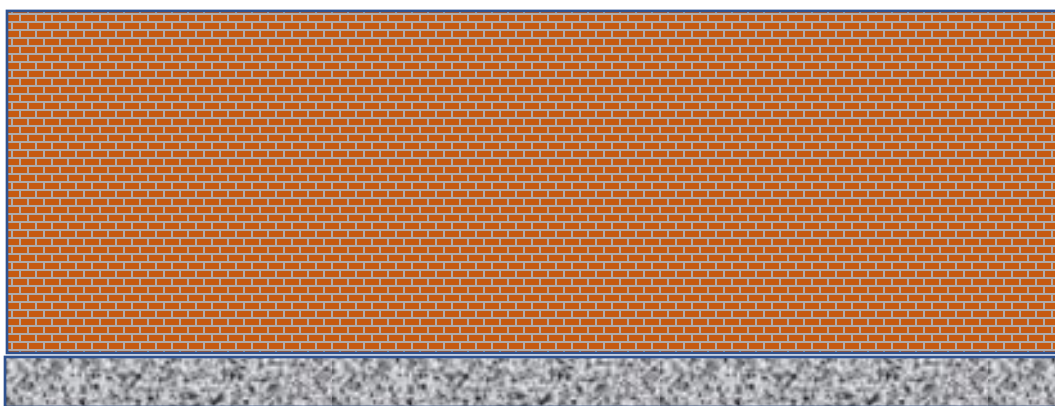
Estado actual mampostería exterior Coliseo león XIII
